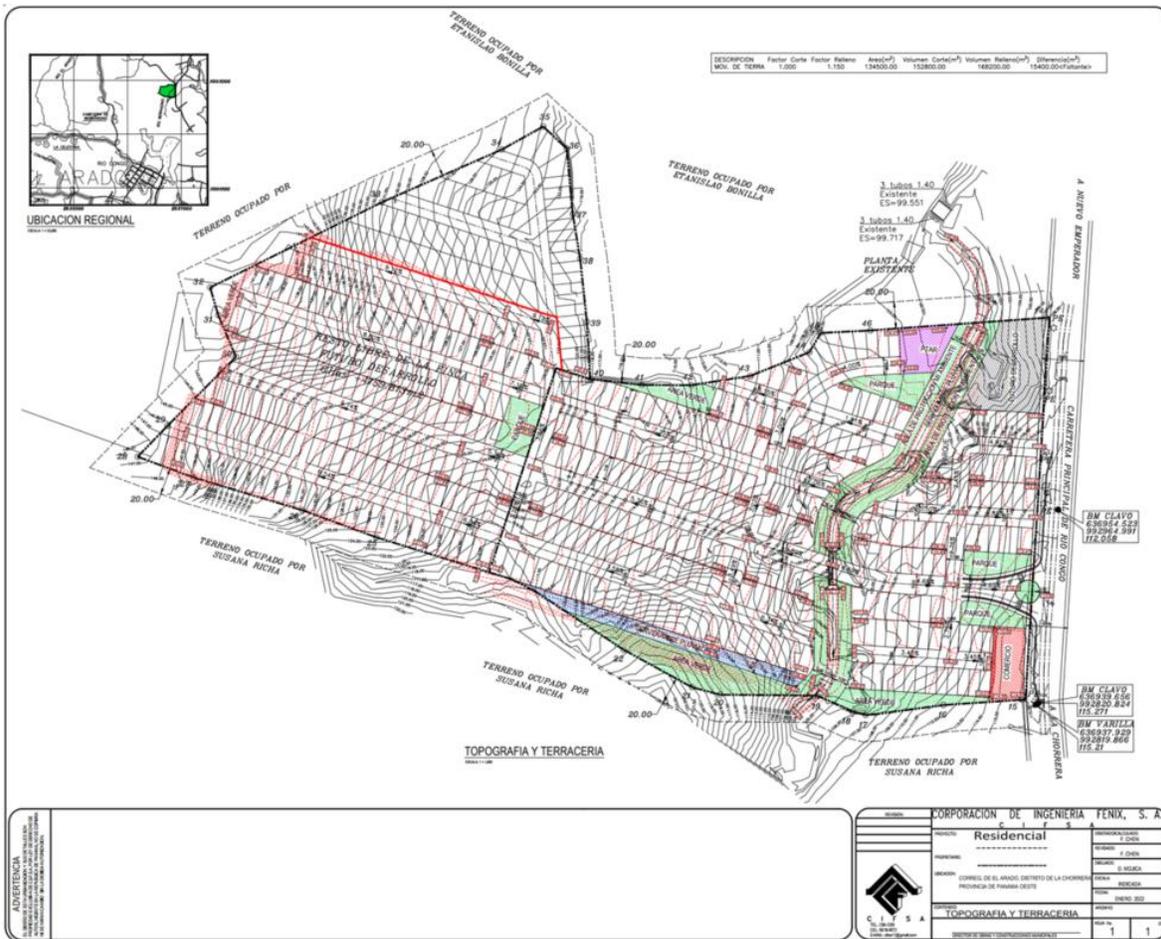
Vista de planta actual del área propuesta para la construcción del residencial. Créditos: Corporación de ingeniería Fenix S.A
